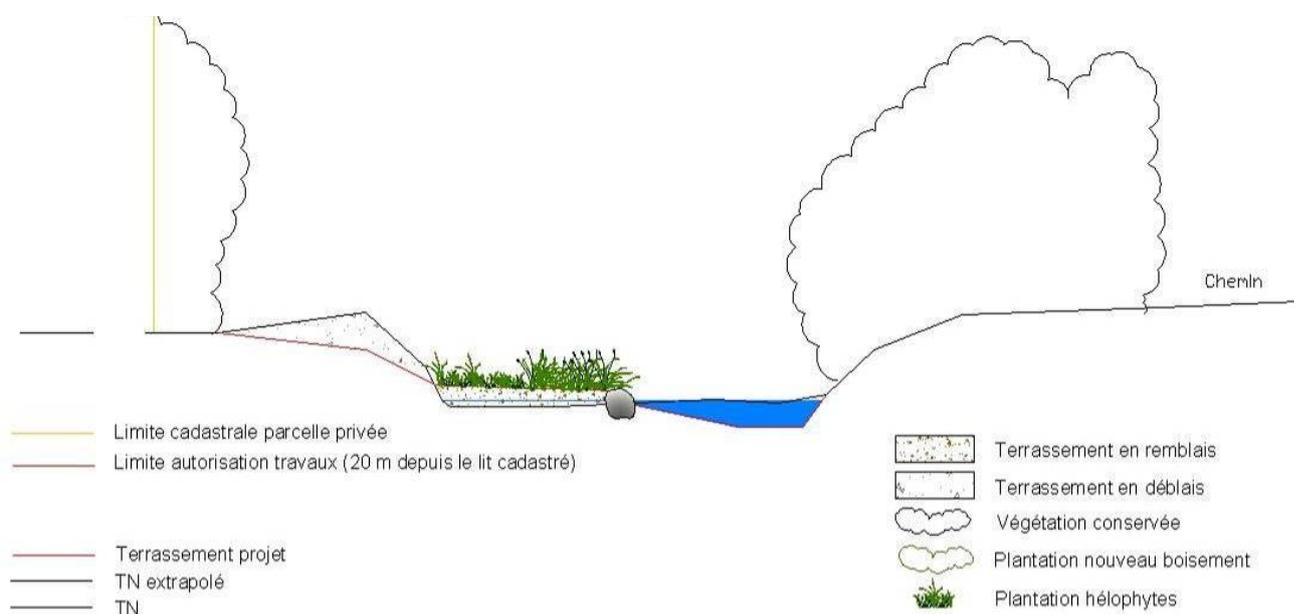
Profil en travers au niveau d'une banquette alternée du tronçon 2a.
